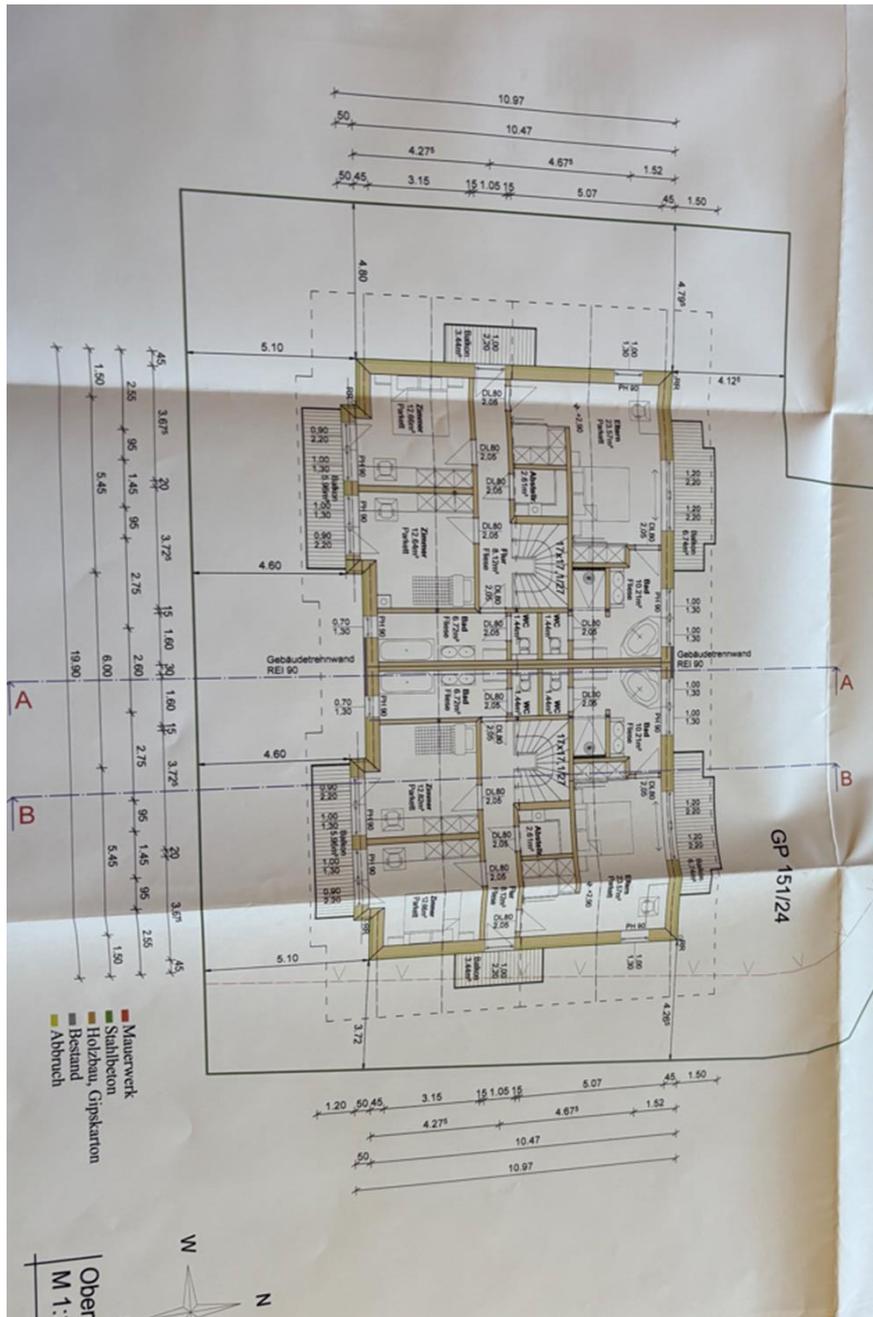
Grundriss 2.Obergeschoss (Einreichplan, v. 17.03.2017)
